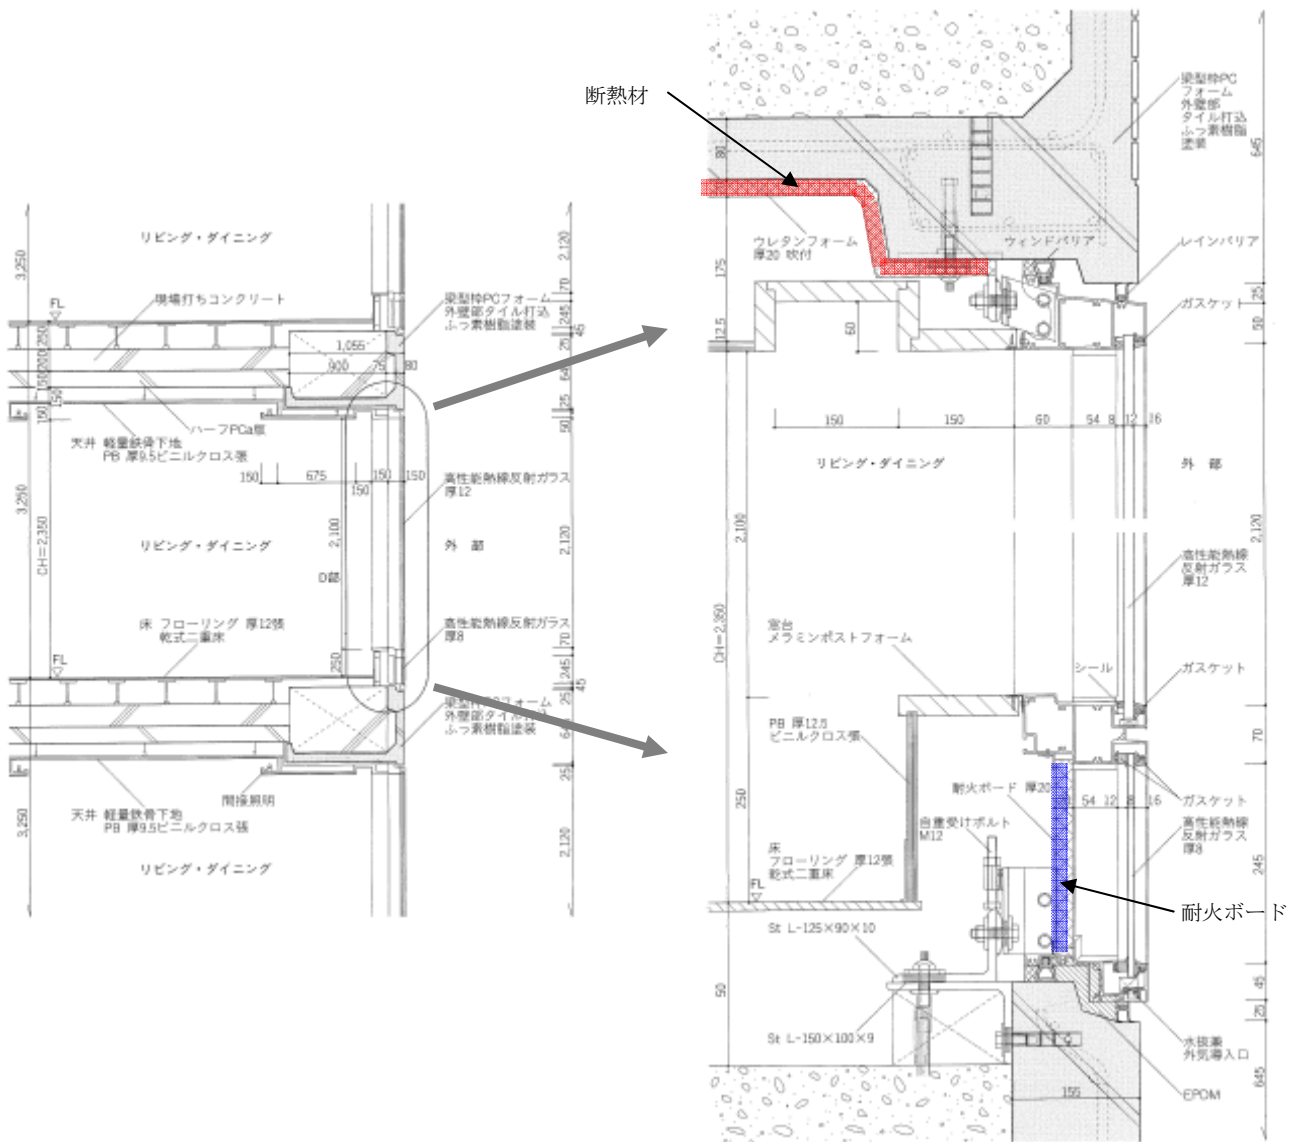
TOKYO TIMES TOWER図面 (断面)
